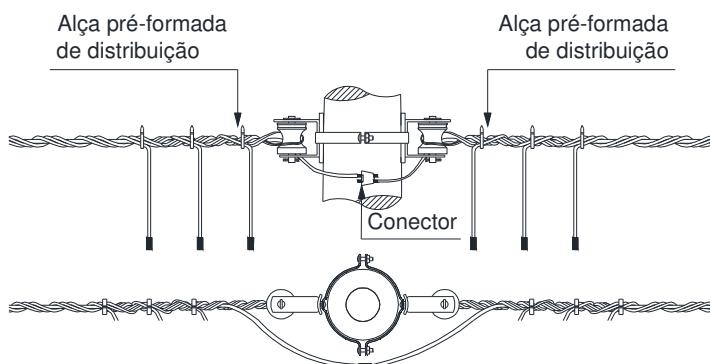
Amarrações e ligações – Estrutura secundária – Fim de rede
